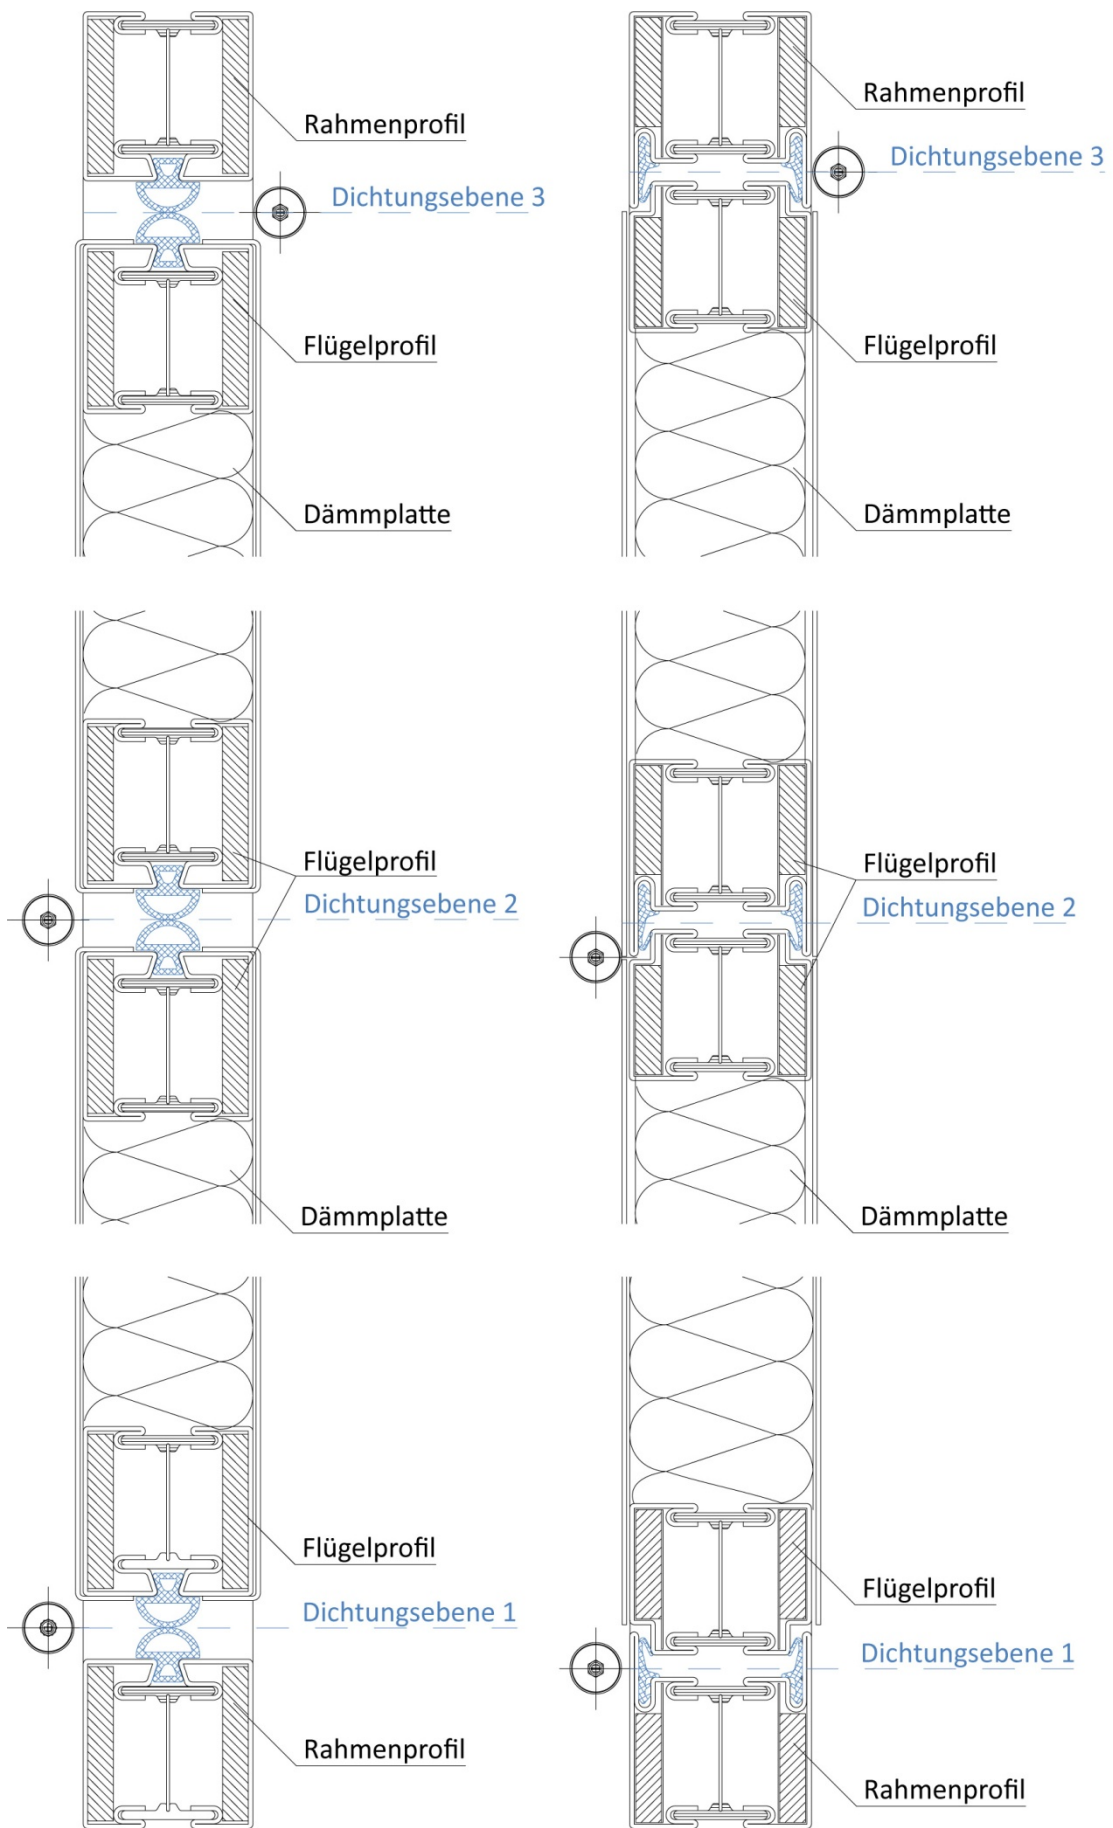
Vertikalschnitt durch einen Dämmladen mit Stahlprofilen (M 1:2)
